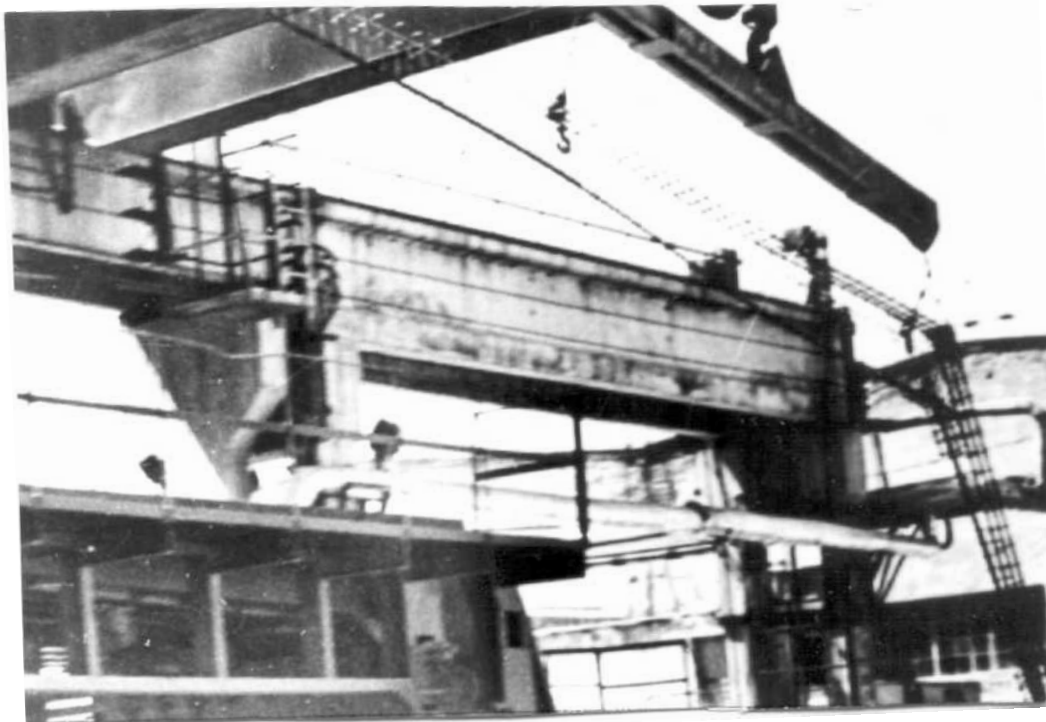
Монтаж арматурного каркасу в касетну форму
